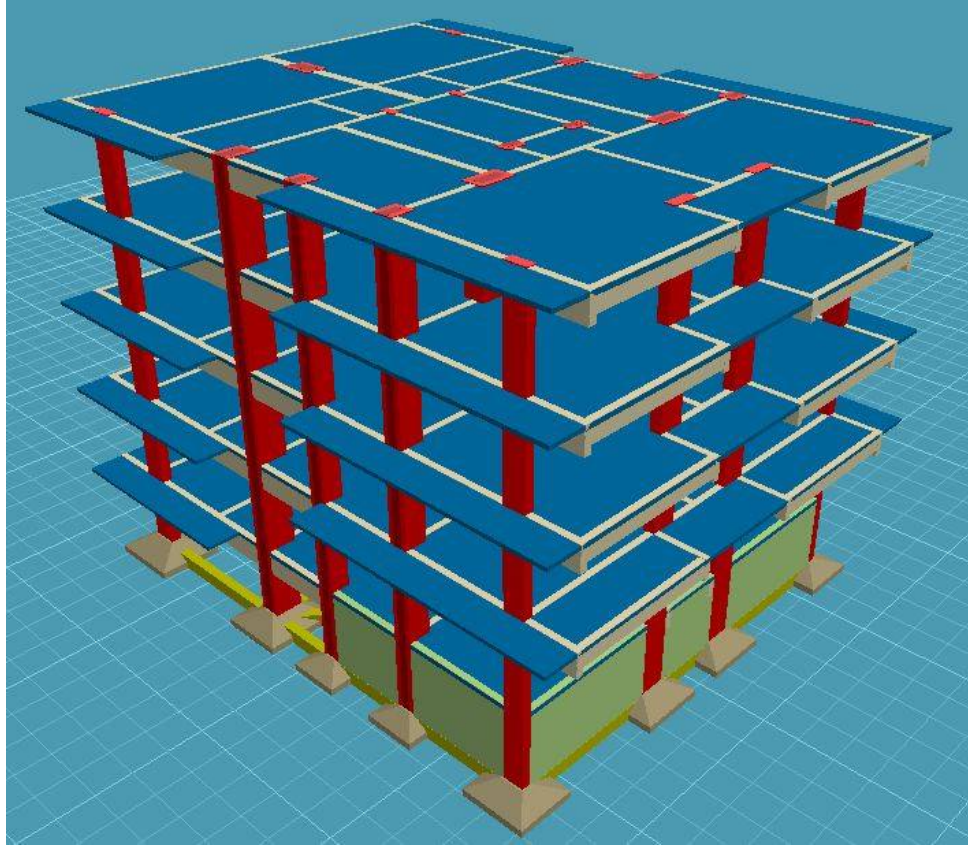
(15) Nolu bina modelleme kat planı
